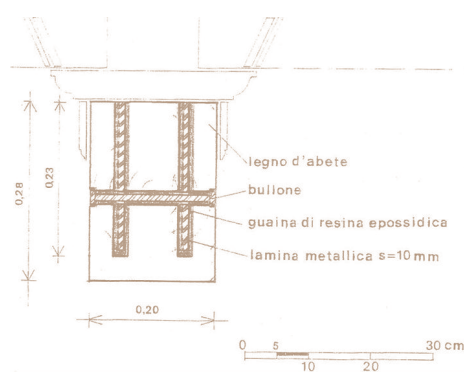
Sezione trasversale della trave rinforzata (primo lotto)
